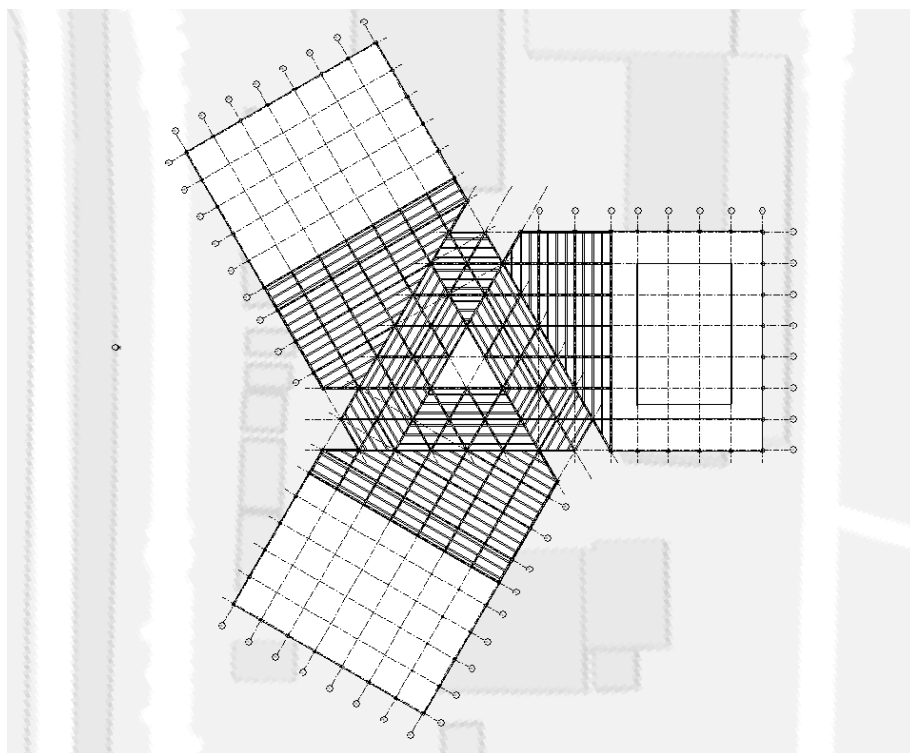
Конструктивна схема будівлі. Розріз по сталевим балкам перекриття другого поверху
